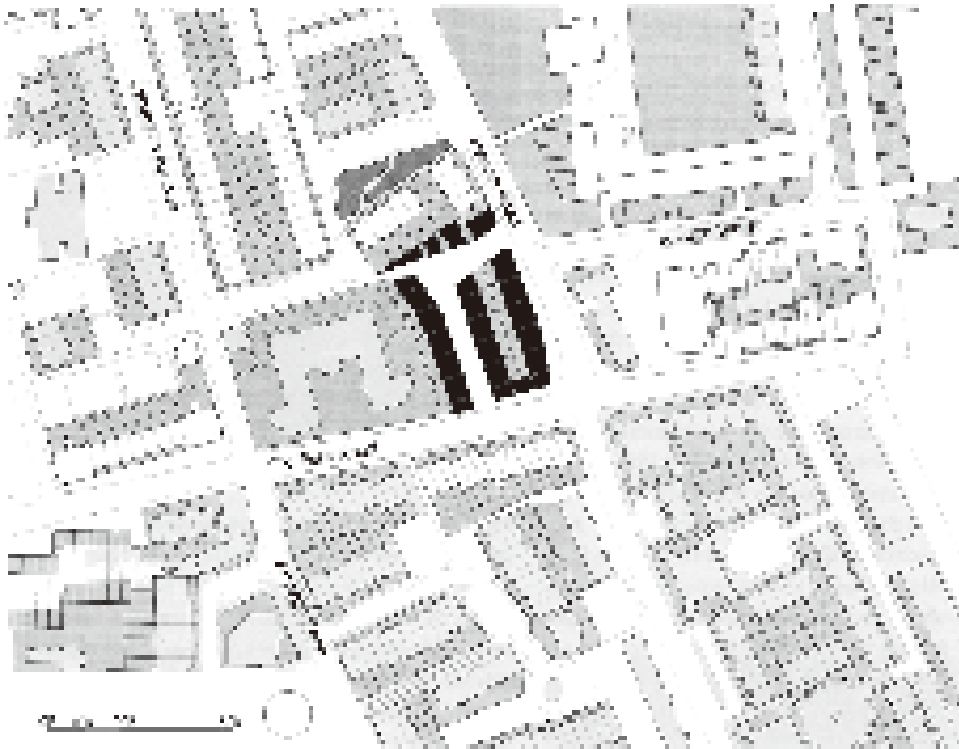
总平面图 (资料来源: Tilman Harlander, Stadt Wohnen Geschichte Staedtebau Perspektiven, Germany, 2007, S.358.)
